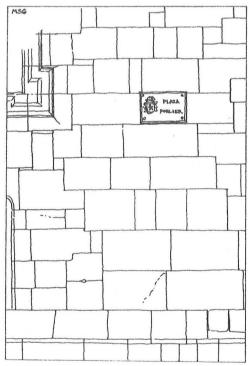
Detalle de la fachada de Poniente del palacio de Camposagrado, en Oviedo.
